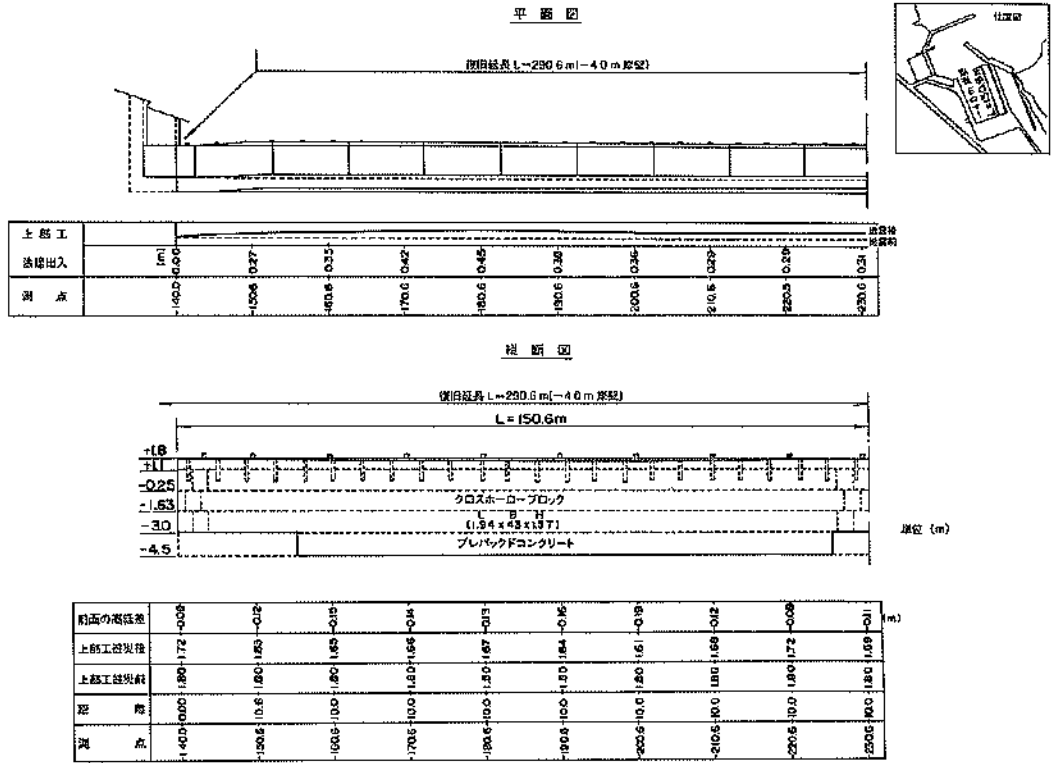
被災状況平面図・縦断面図(須築漁港、①-4.0m岸壁、SP43.0~140.0)
